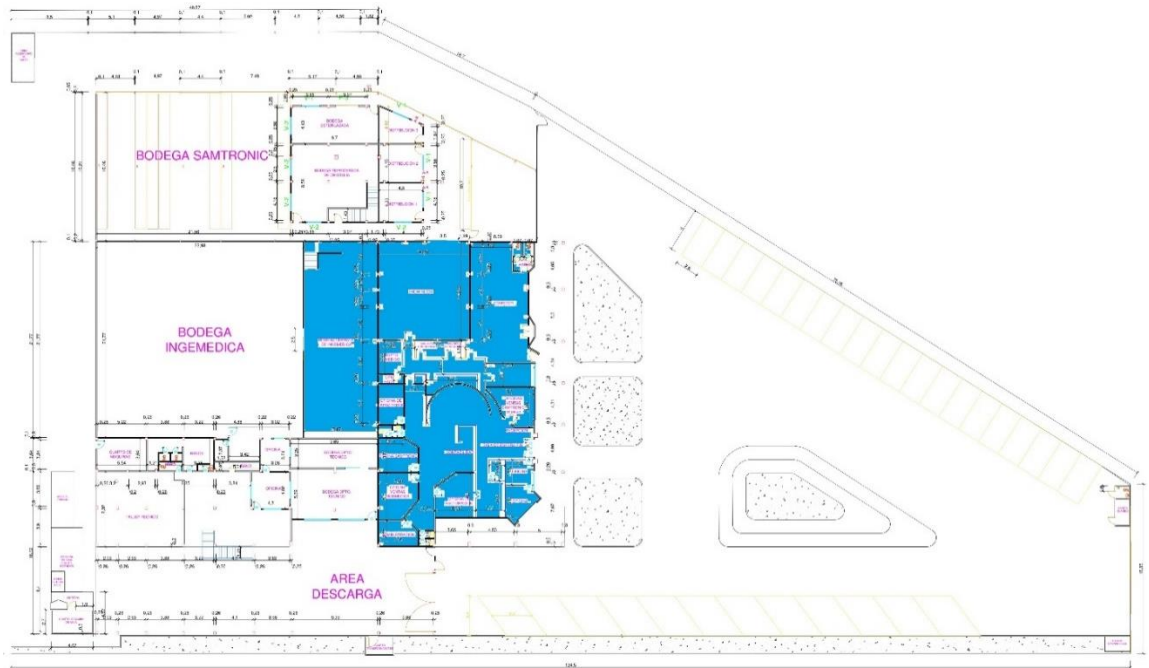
Requerimiento de Cobertura en la Planta Baja
